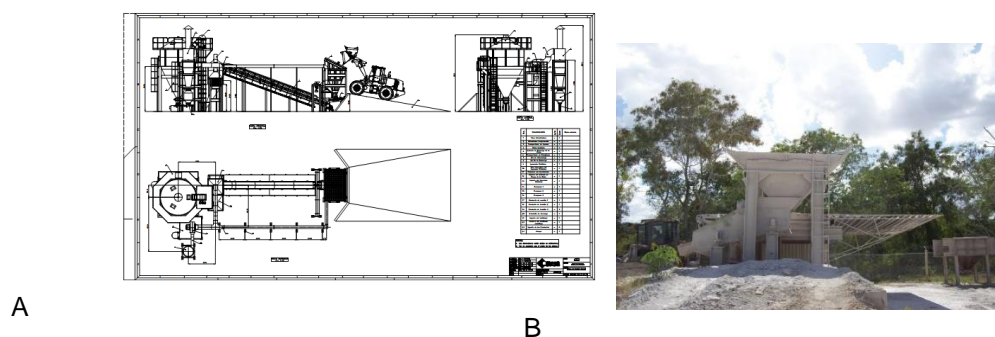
A-Diseño de planta de beneficio. B-Imágenes de la planta de beneficio.
